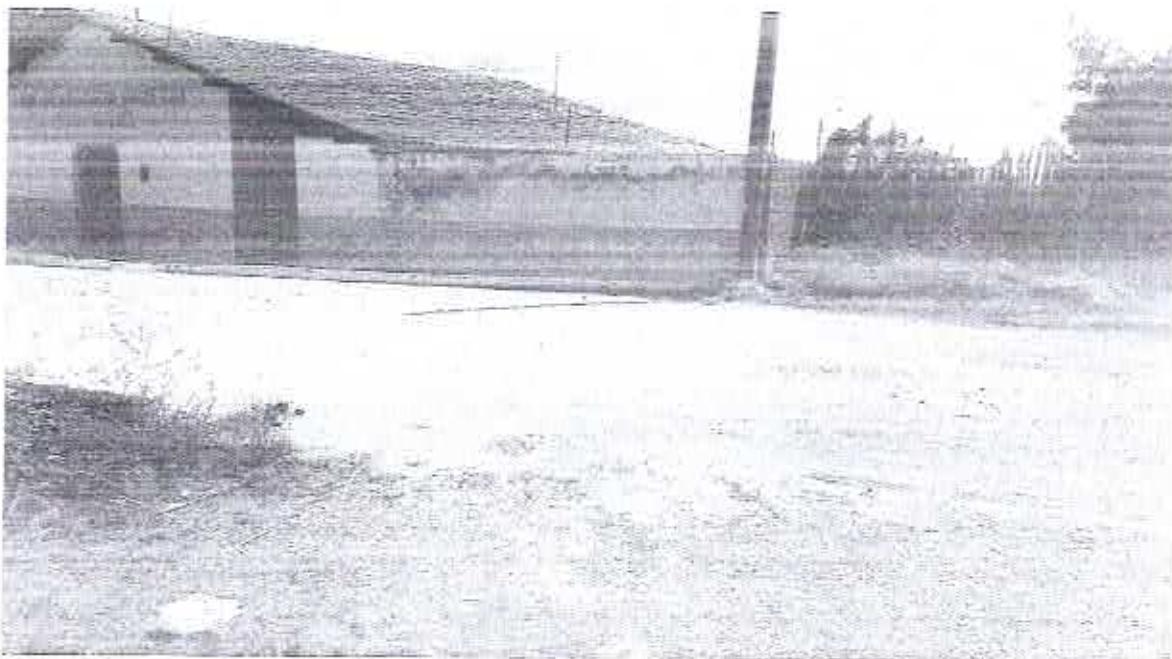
Detalhe de Calçadas, Degraus, Rampas.
